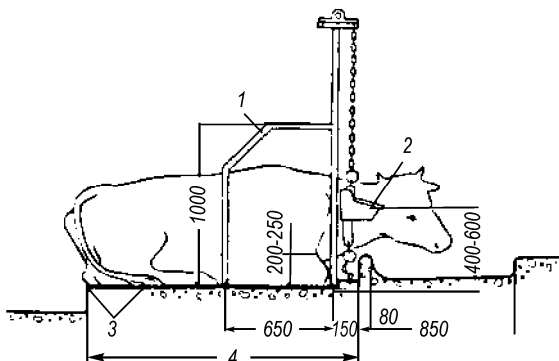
Боковой вид короткого стойла (с лежащей коровой):
